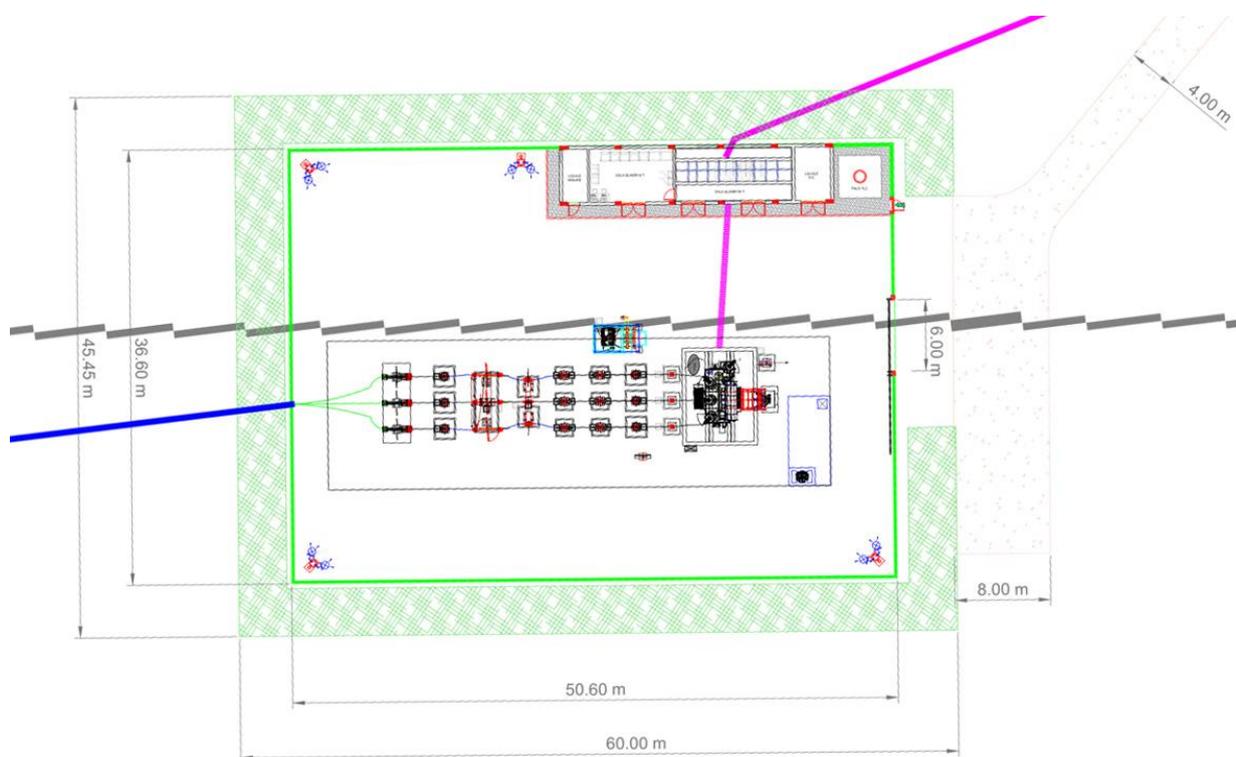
Planimetria della Stazione di Elevazione Utente SEU
